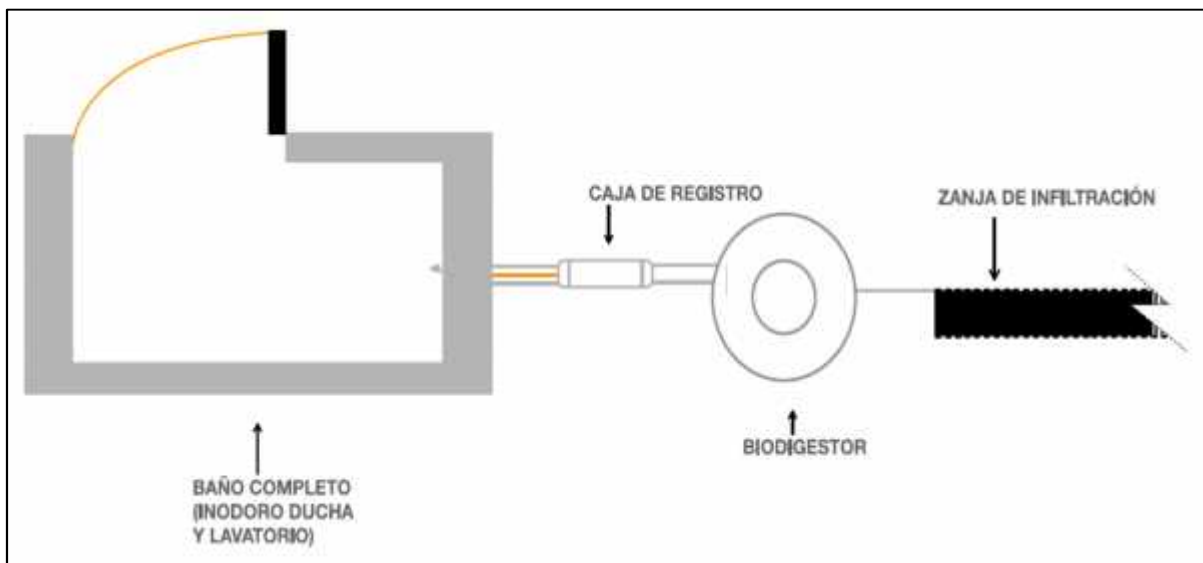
UBS-AH con Biodigestor y zanja de Percolación. Vista de Planta.
